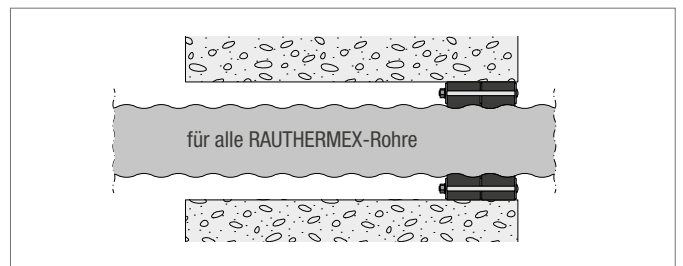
Hauseinführung mit Mauerdichtflansch FA 80
